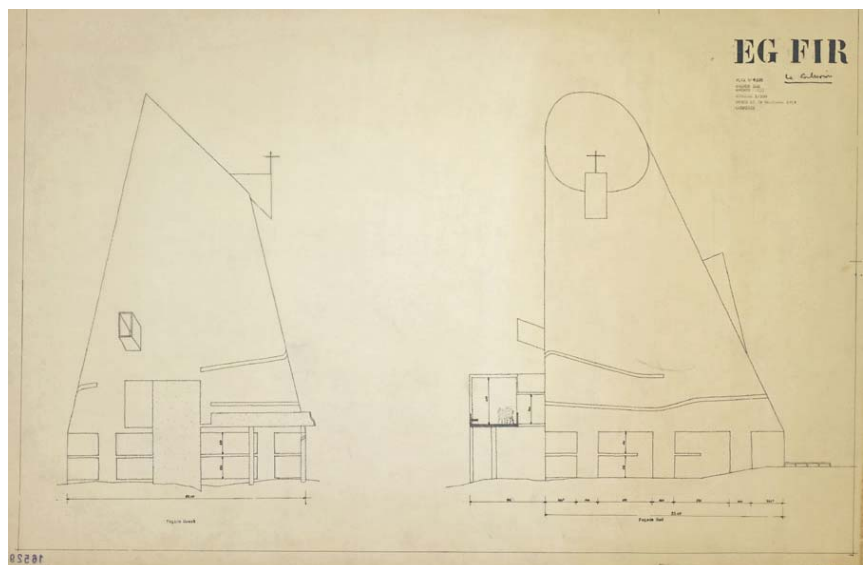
Dibujo de las fachadas oeste y sur perteneciente al proyecto final. Fuente: FLC. 16529A
